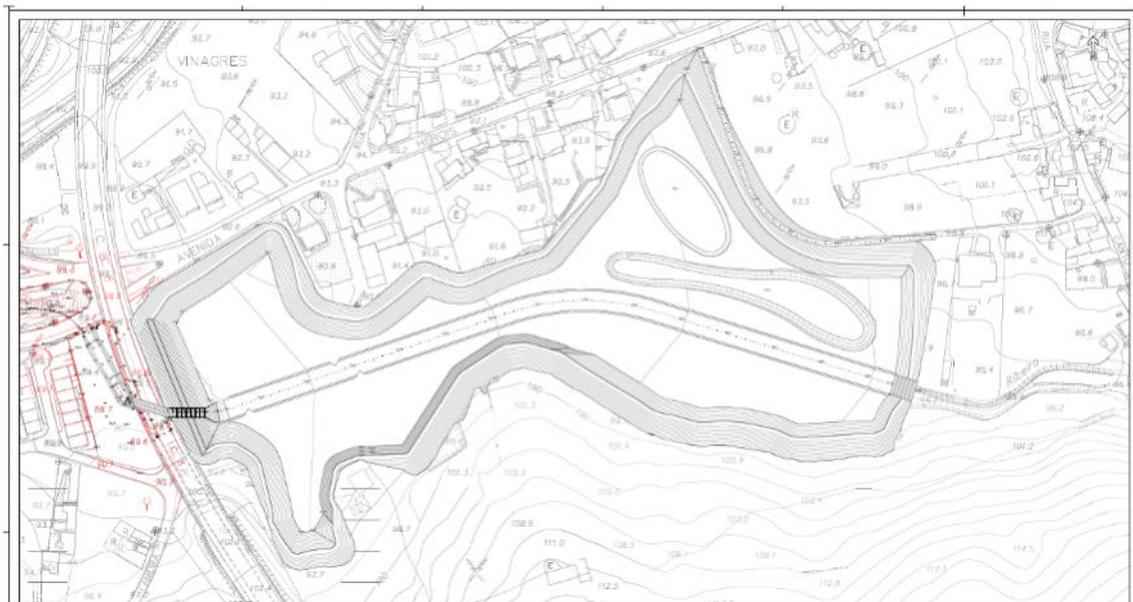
Implantação da Bacia de Amortecimento. (Fonte: Projeto Execução, 2023).
